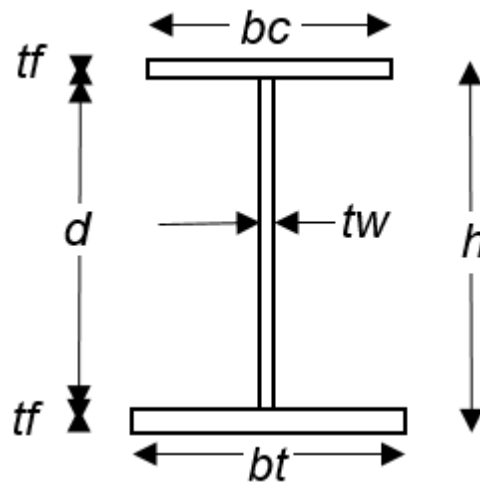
Forma y partes de viga metálica. Elaborado por: Autor
